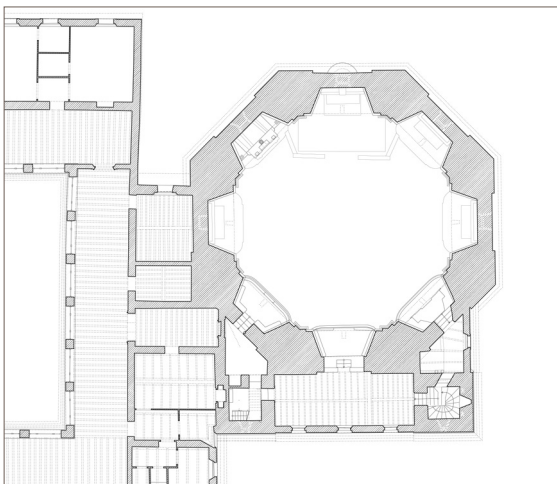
Stadtgrundriss Bestand, nördlicher Bereich (Ausschnitt). Zeichnung: Forschungsstelle Baugeschichte und Denkmalpflege, RWTH Aachen University, Prof. Dr. Jan Pieper.
